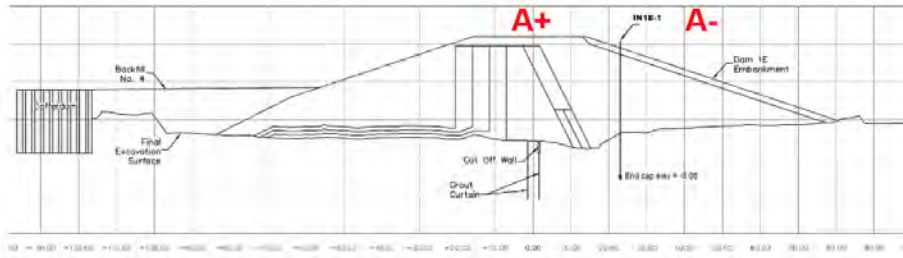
Inclínómetro IN1E-01, Sección estación 1+900
